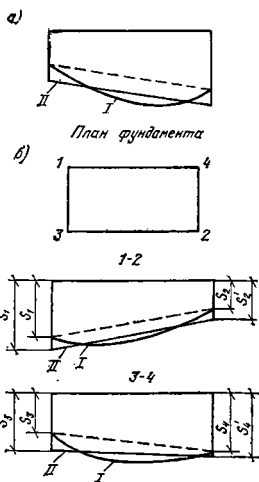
Схемы к определению осадки жесткого фундамента
